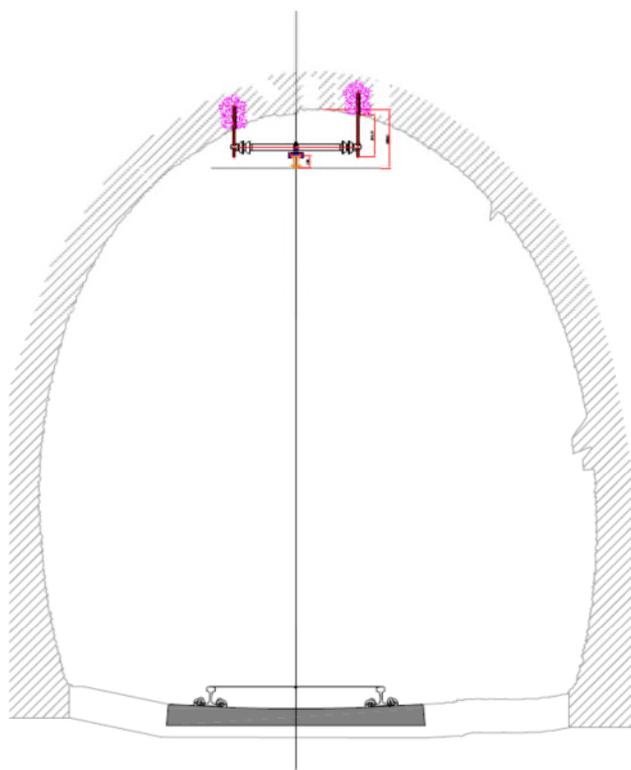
Sezione tipo 3 kV cc in galleria con catenaria rigida
